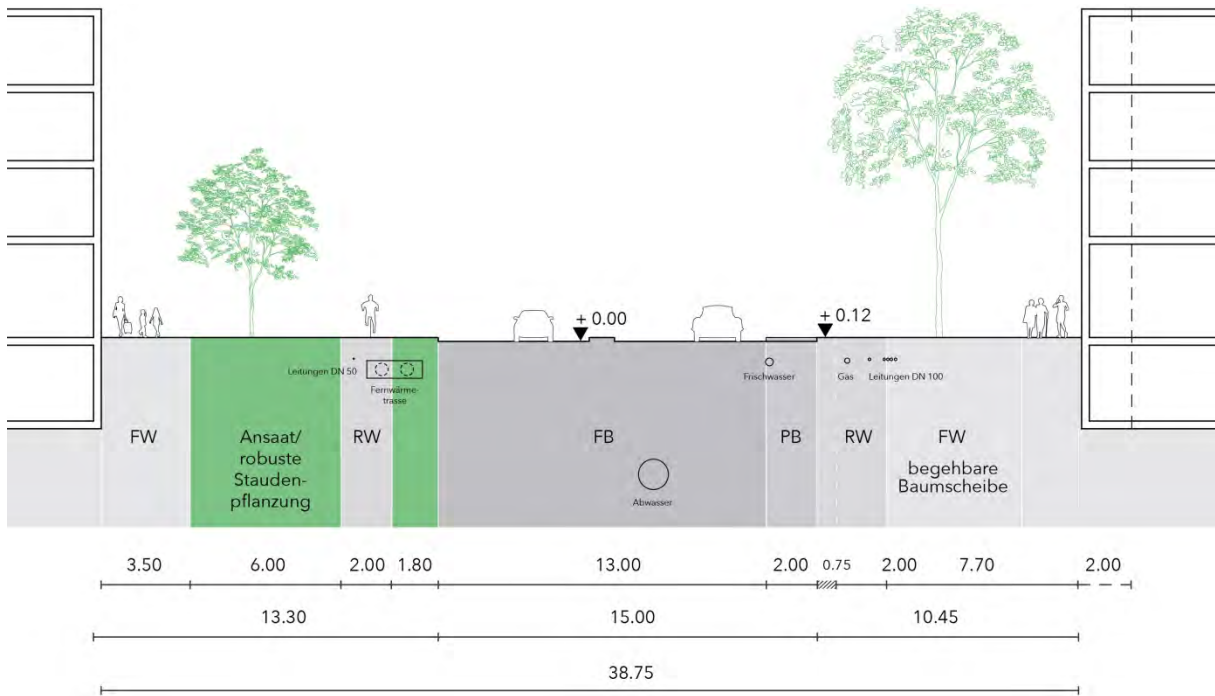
Straßenquerschnitt Römerstraße – Variante 1, Quelle: Teleinternetcafé GbR / TH Treibhaus
